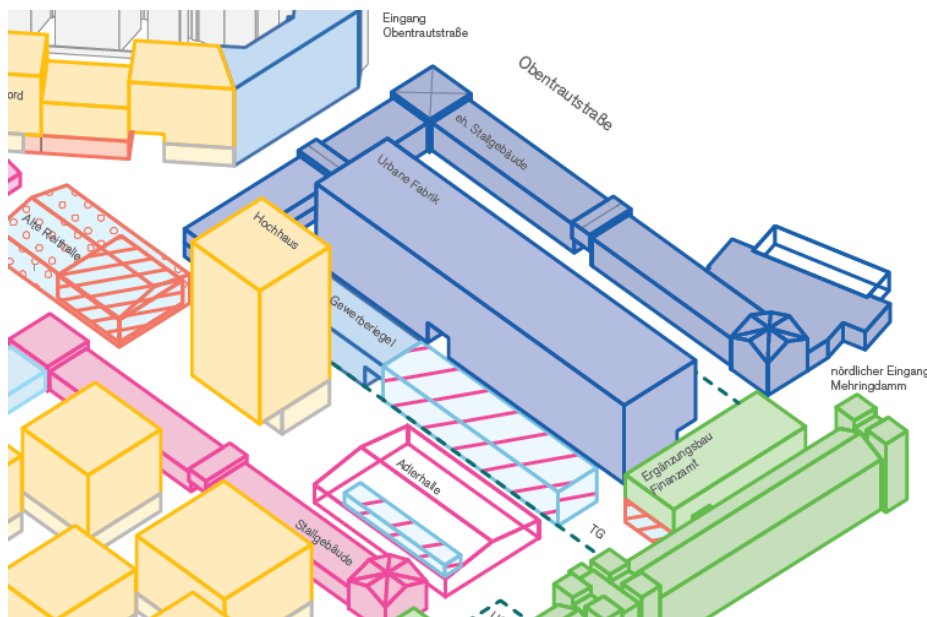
Ausschnitt städtebaulicher Entwurf (Axonometrie) - nördlich des Wohnhochhauses liegt der Gewerberiegel, dahinter die Urbane Fabrik
